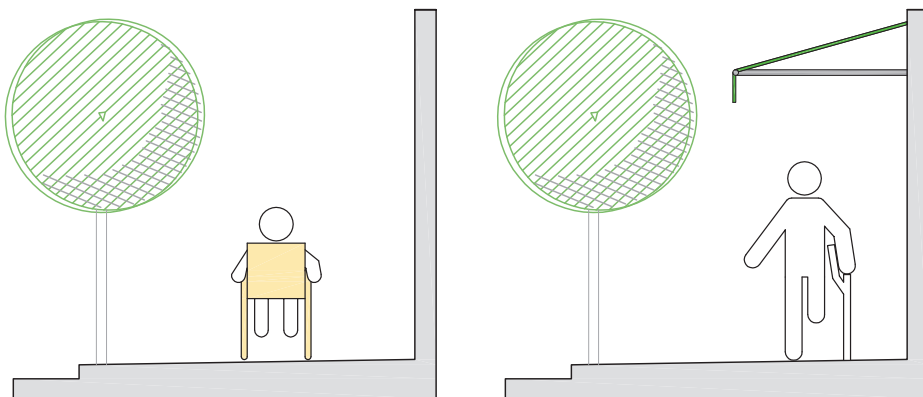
Encaminamiento con pavimento táctil direccional junto a línea de fachada.
